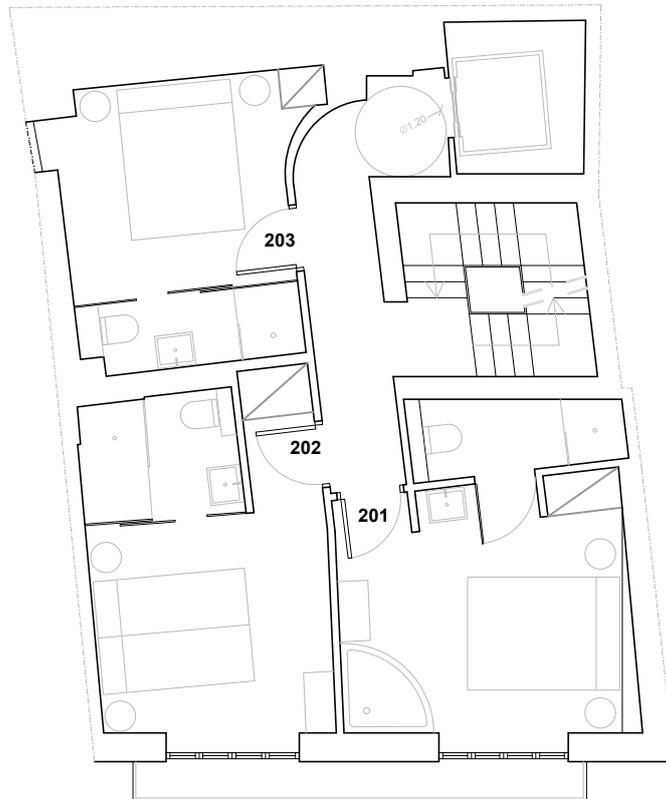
Planta Segunda Edificio Propuesta, Fuente: Elaboración Propia
